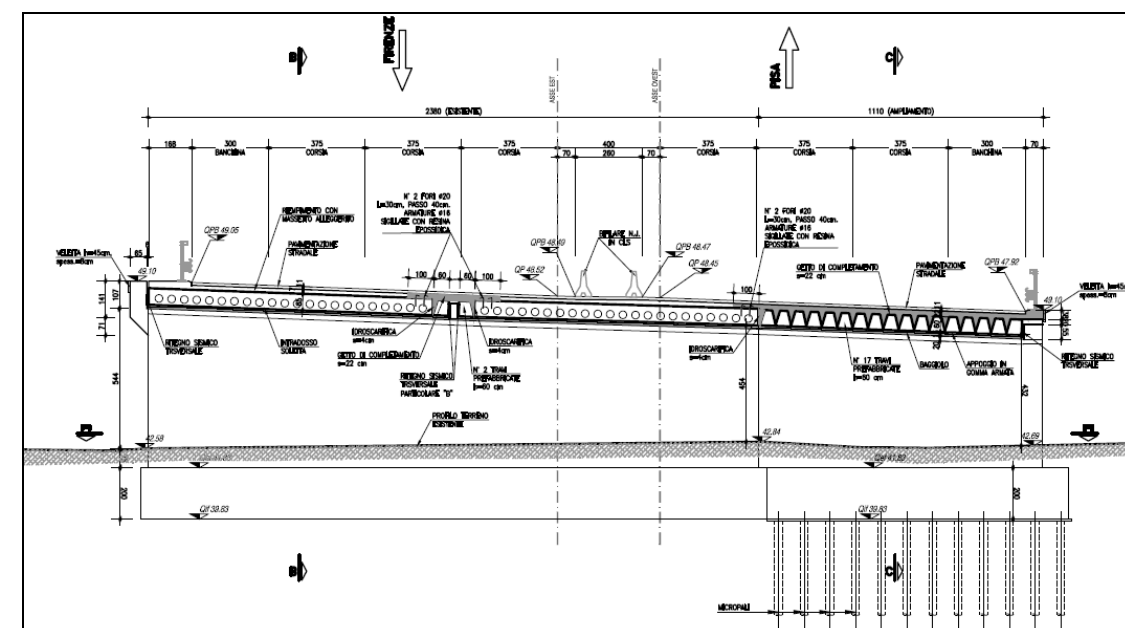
Sottovia nuovo PRG. Sezione trasversale
